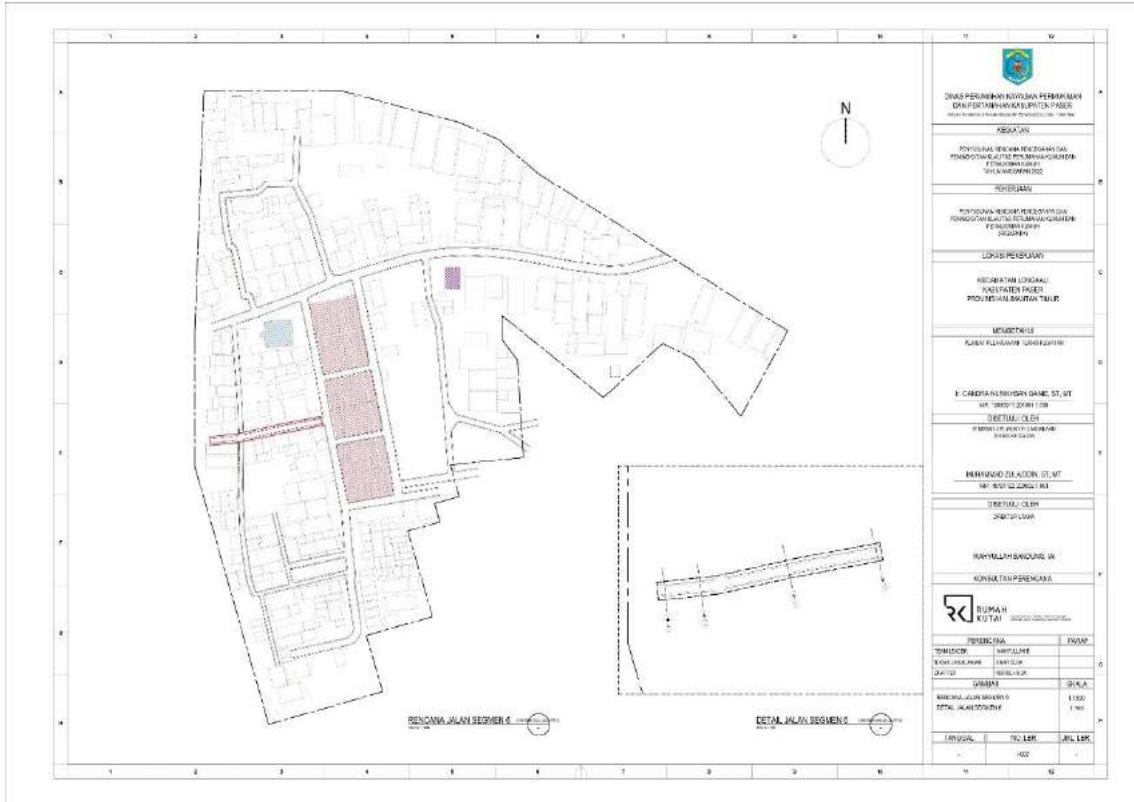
7 Konsep Recana Jalan Eksisting RT.02
